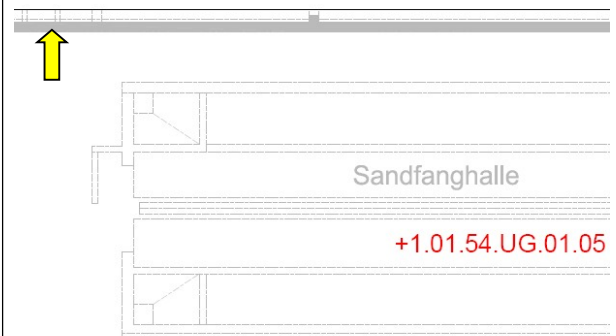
Brandschutzklappe Lage in der Sandfanghalle
